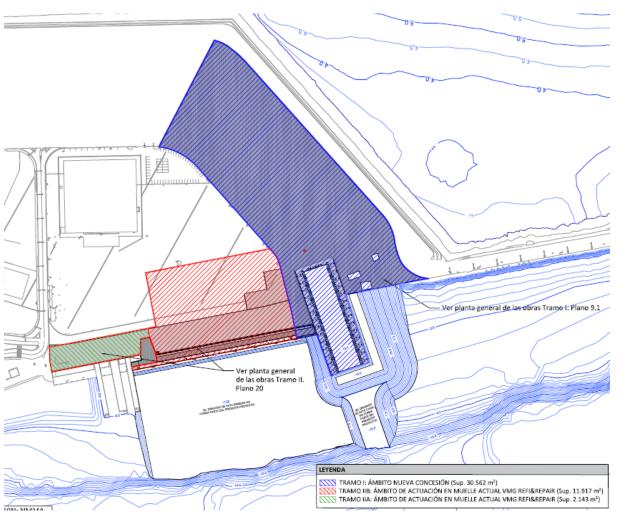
Tramos I y II. Ámbitos de actuación del Proyecto Constructivo de obra civil para instalación de un nuevo shiplift y pavimentación de la explanada Norte en el Puerto de Sagunto.
